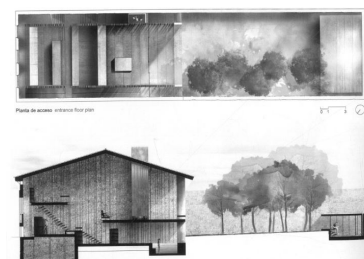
Planta y sección Casa entremuros, Girona, 2012, RCR.
